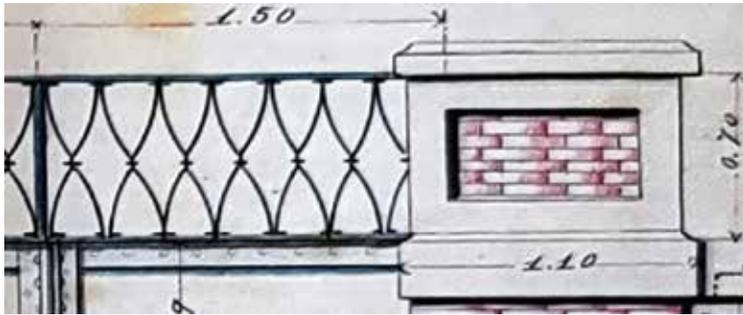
Arriba: una ampliación parcial del dibujo de 1892 de Pedro Fernández para las barandas metálicas de seguridad, muy similar a la construcción final encontrada en un grupo reducido de alcantarillas, puentes y pontones —todos muy cercanos entre sí— en el tramo Ponce-Adjuntas de la Carretera Núm. 6.
